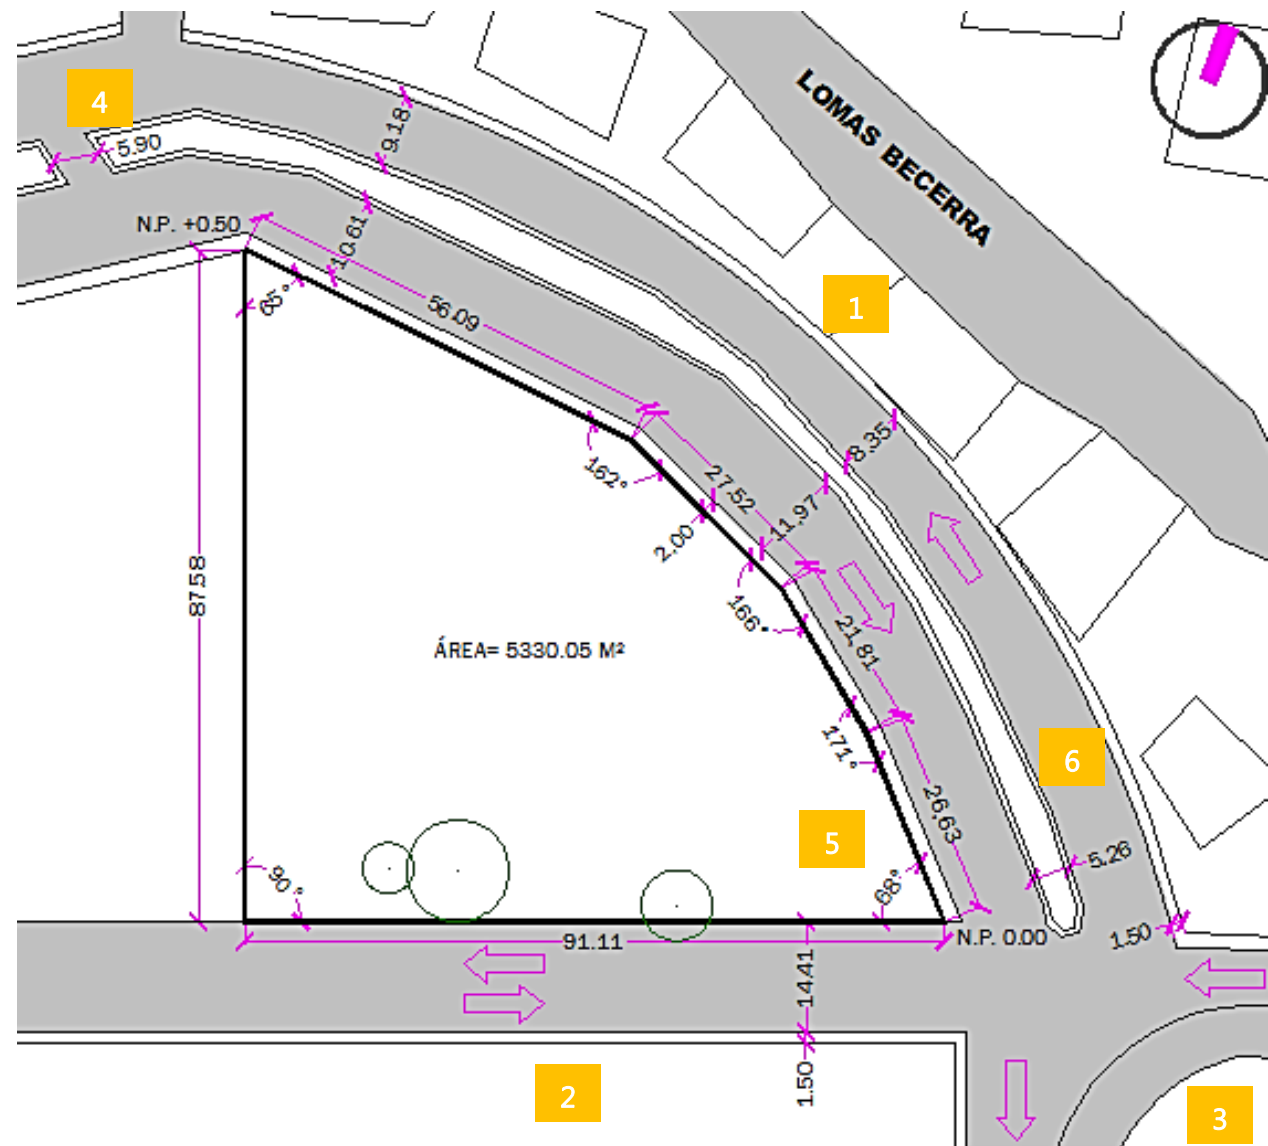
PLANTA DE LEVANTAMIENTO DEL TERRENO.
